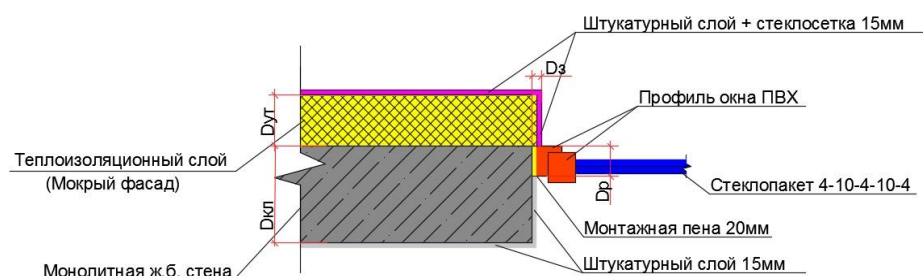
Монолитная стена с наружным утеплением типа мокрый фасад
